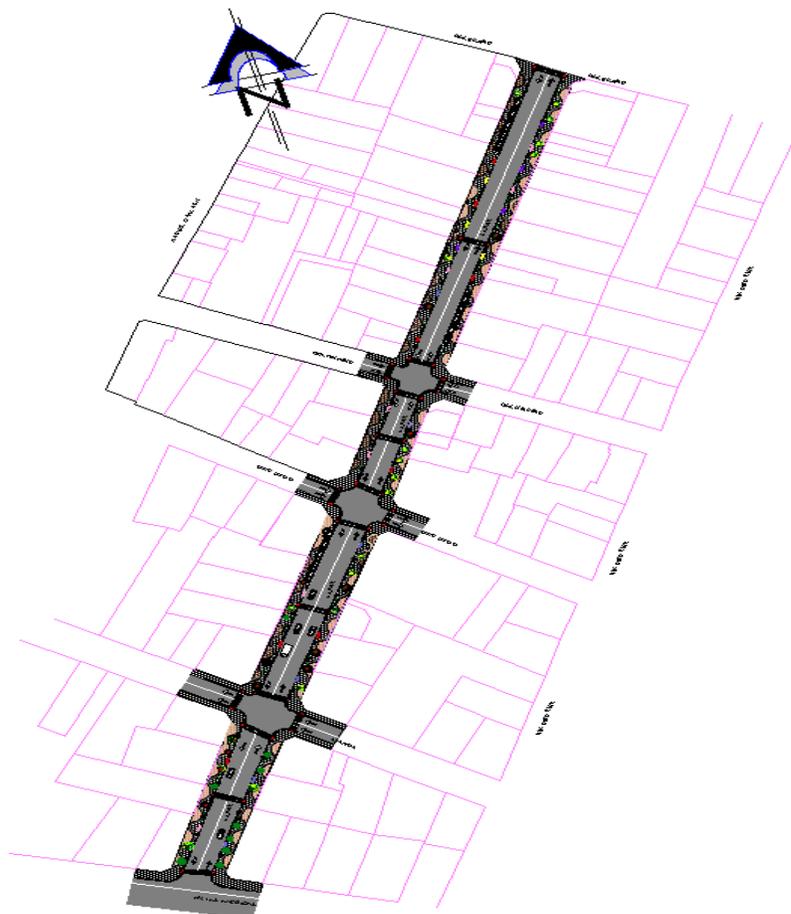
Plano con Propuesta de la avenida La Paz
